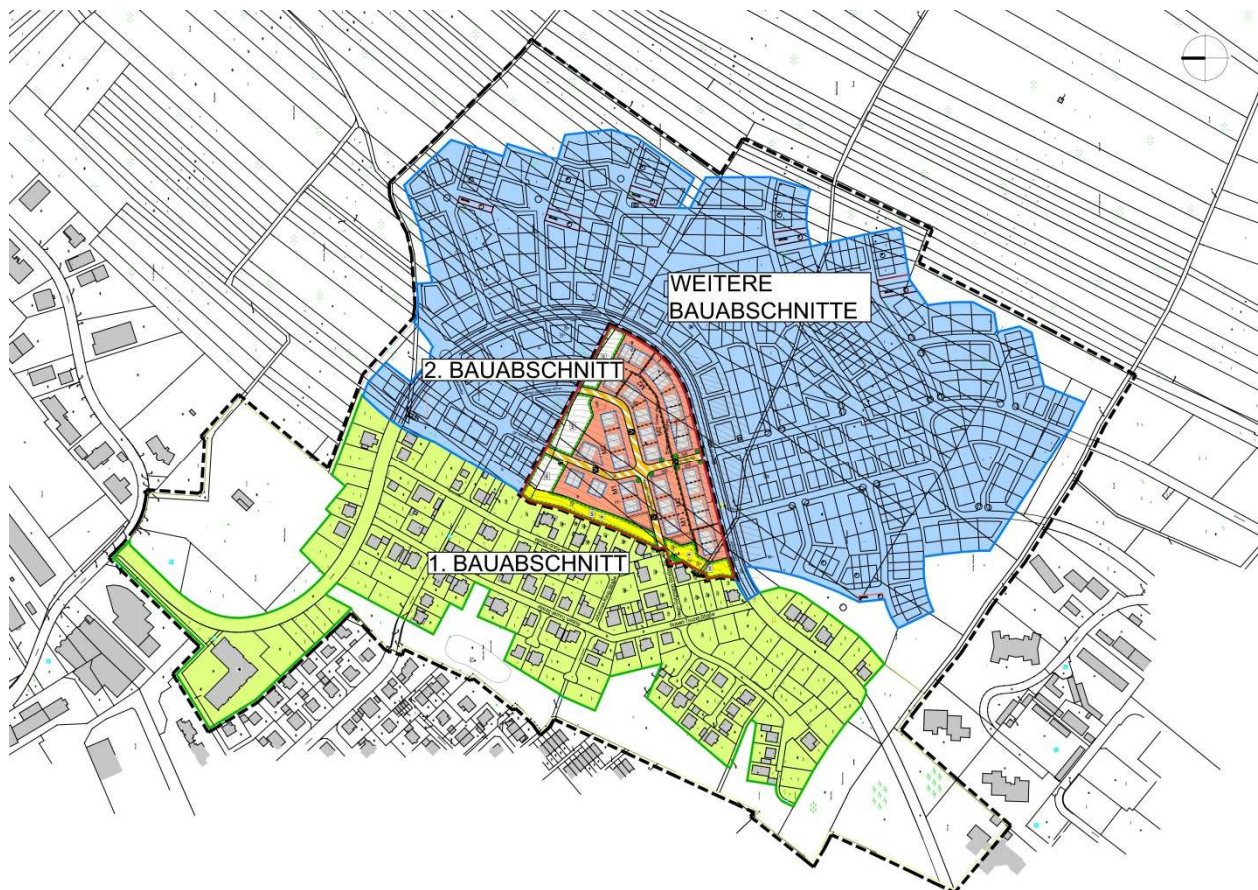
Übersichtsplan Baugebiet "In den Weingärten" mit Bauabschnitten
